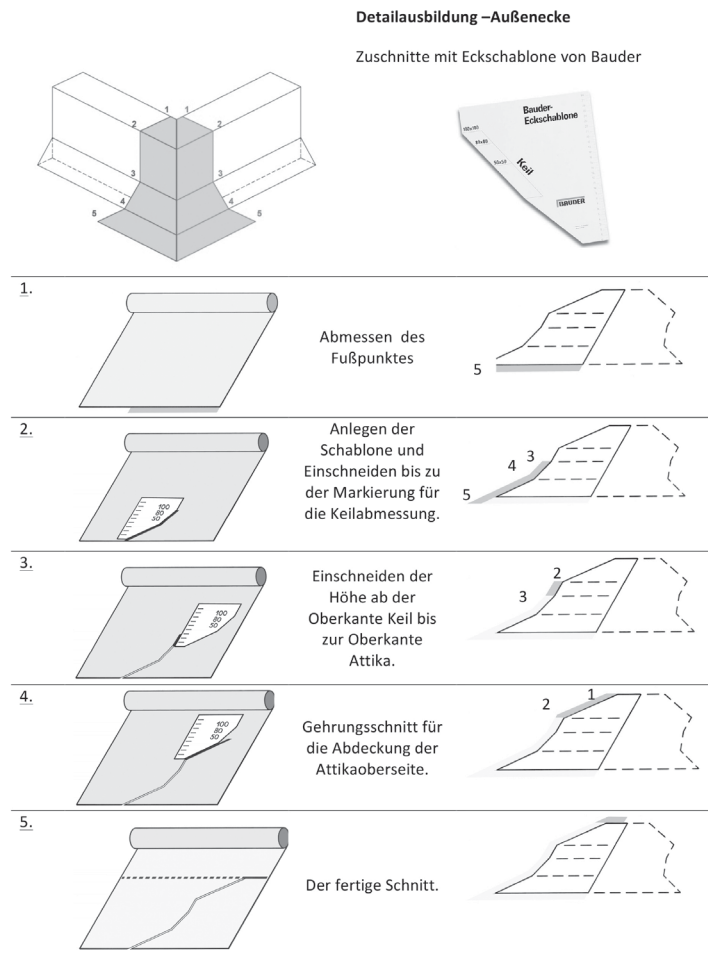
Teilnehmer Handout „Zuschnitt Detailausbildung-Außenecke“
